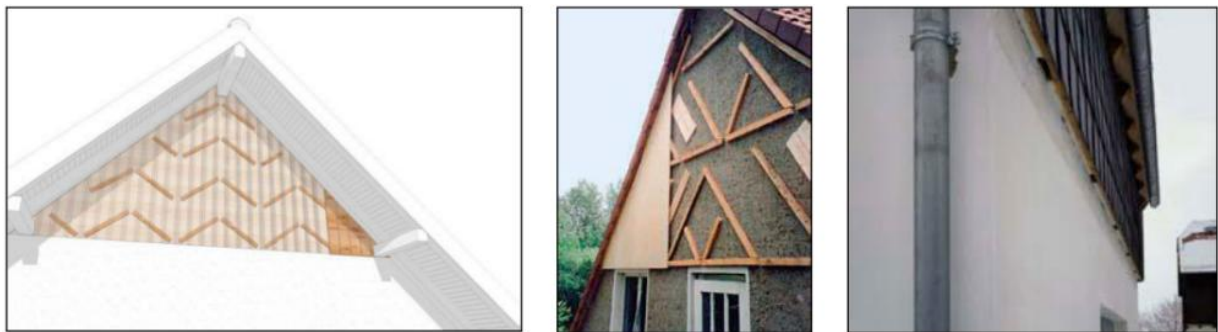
Bardage bois sur la façade extérieure (Source : Cerema Est)
